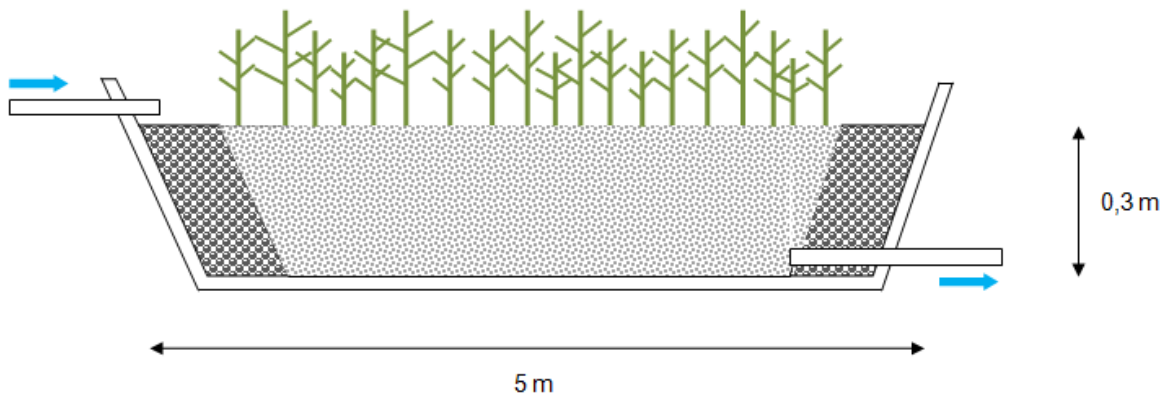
Diseño del humedal construido en alzado (fuente propia)
